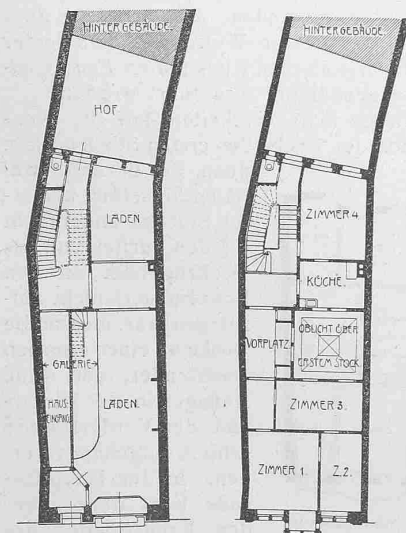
Wohn- u. Geschäftshaus K. J. Wyss. Grundrisse vom Erdgeschoss und II. Stock. Masstab 1:400.
